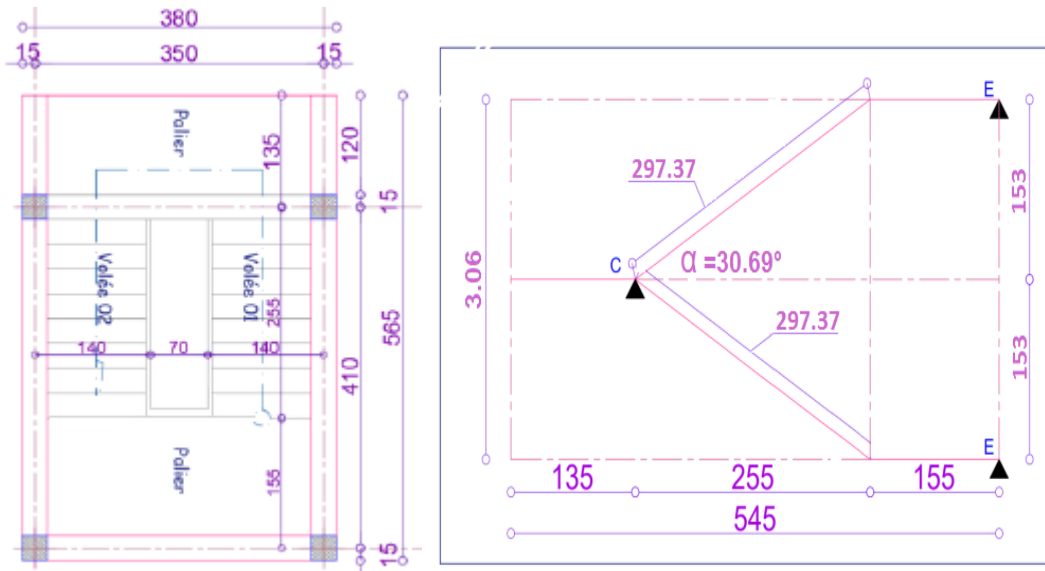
Vue en plan et schéma statique de l'escalier RDC
